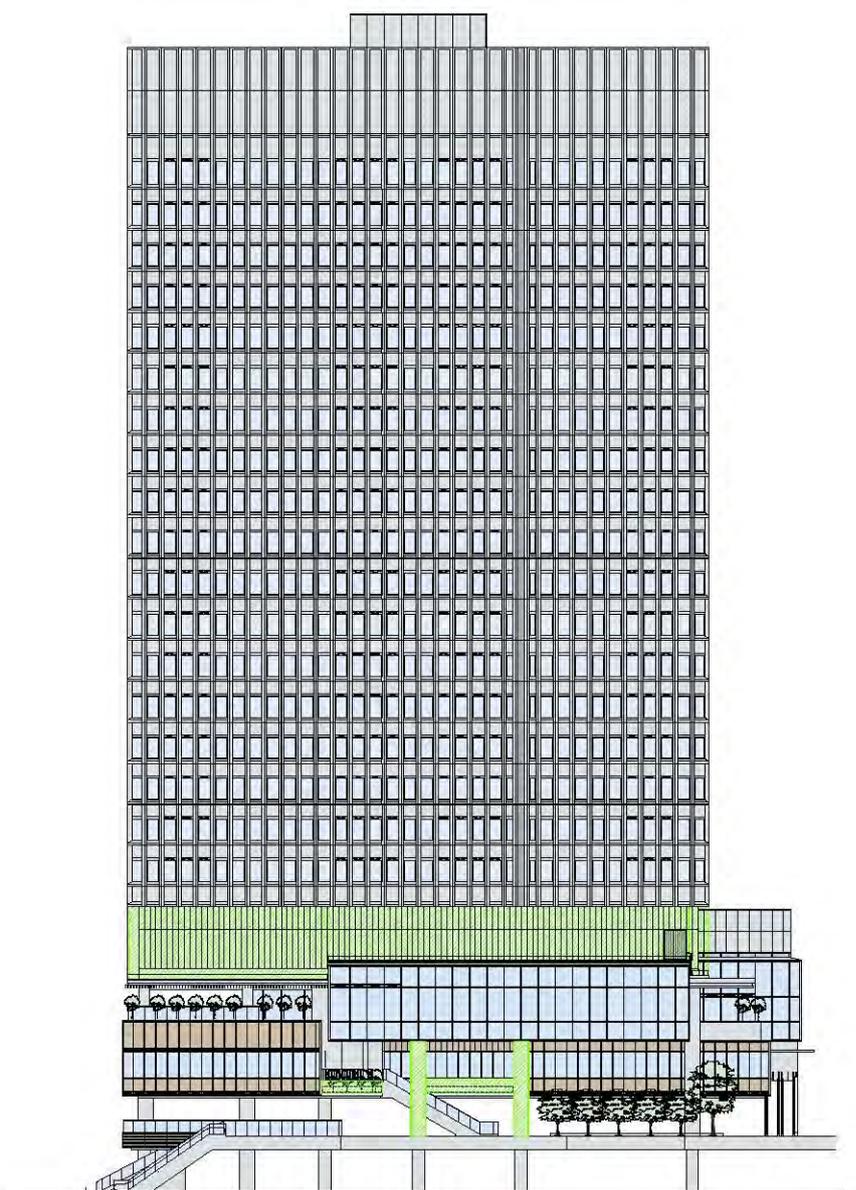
(1) 立面図 (西立面図 S=1:800) 【変更後】
